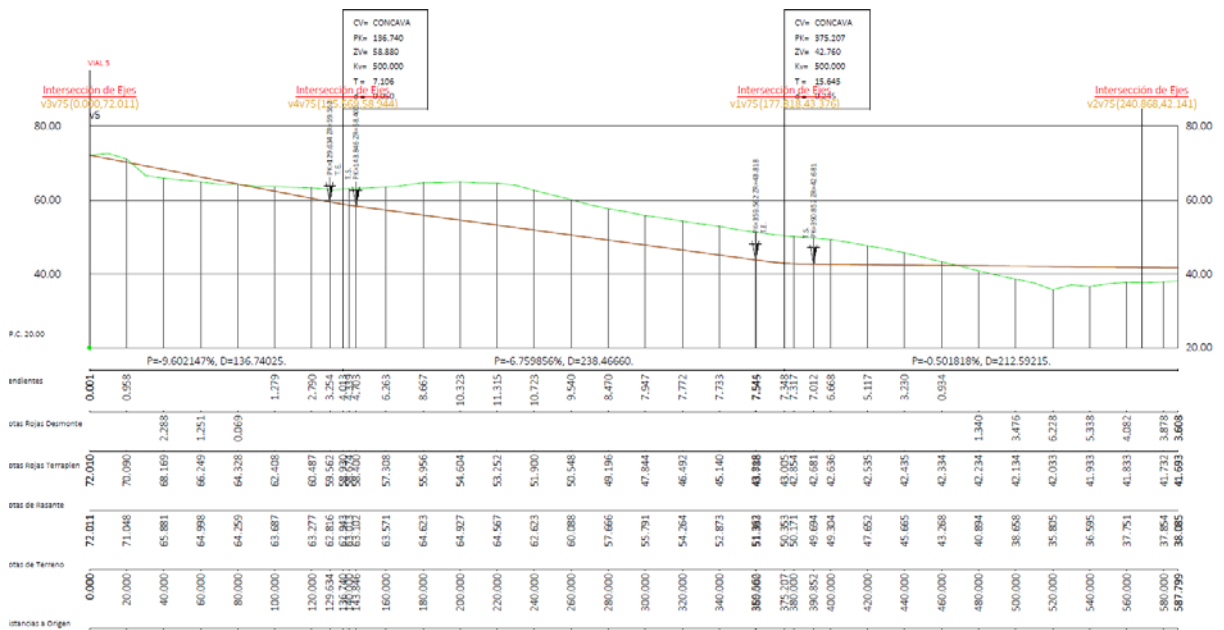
Imagen de la sección longitudinal del vial 5 en la alternativa 1.
